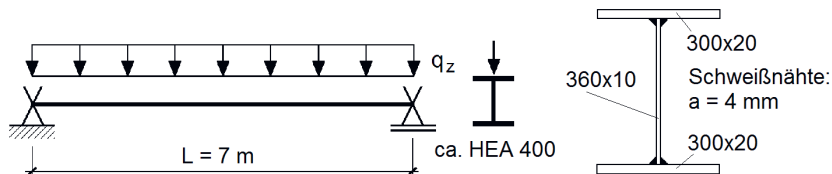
Träger aus einem geschweißten I-Profil (ca. HEA 400)
